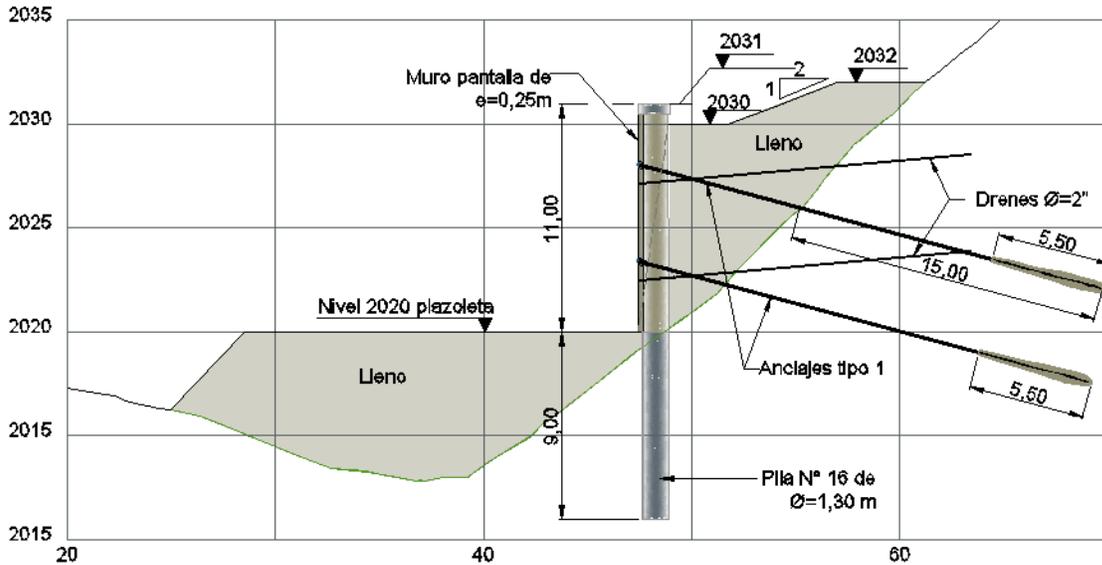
Sección tablestacado y modulación anclajes Box Q. Aguadita
